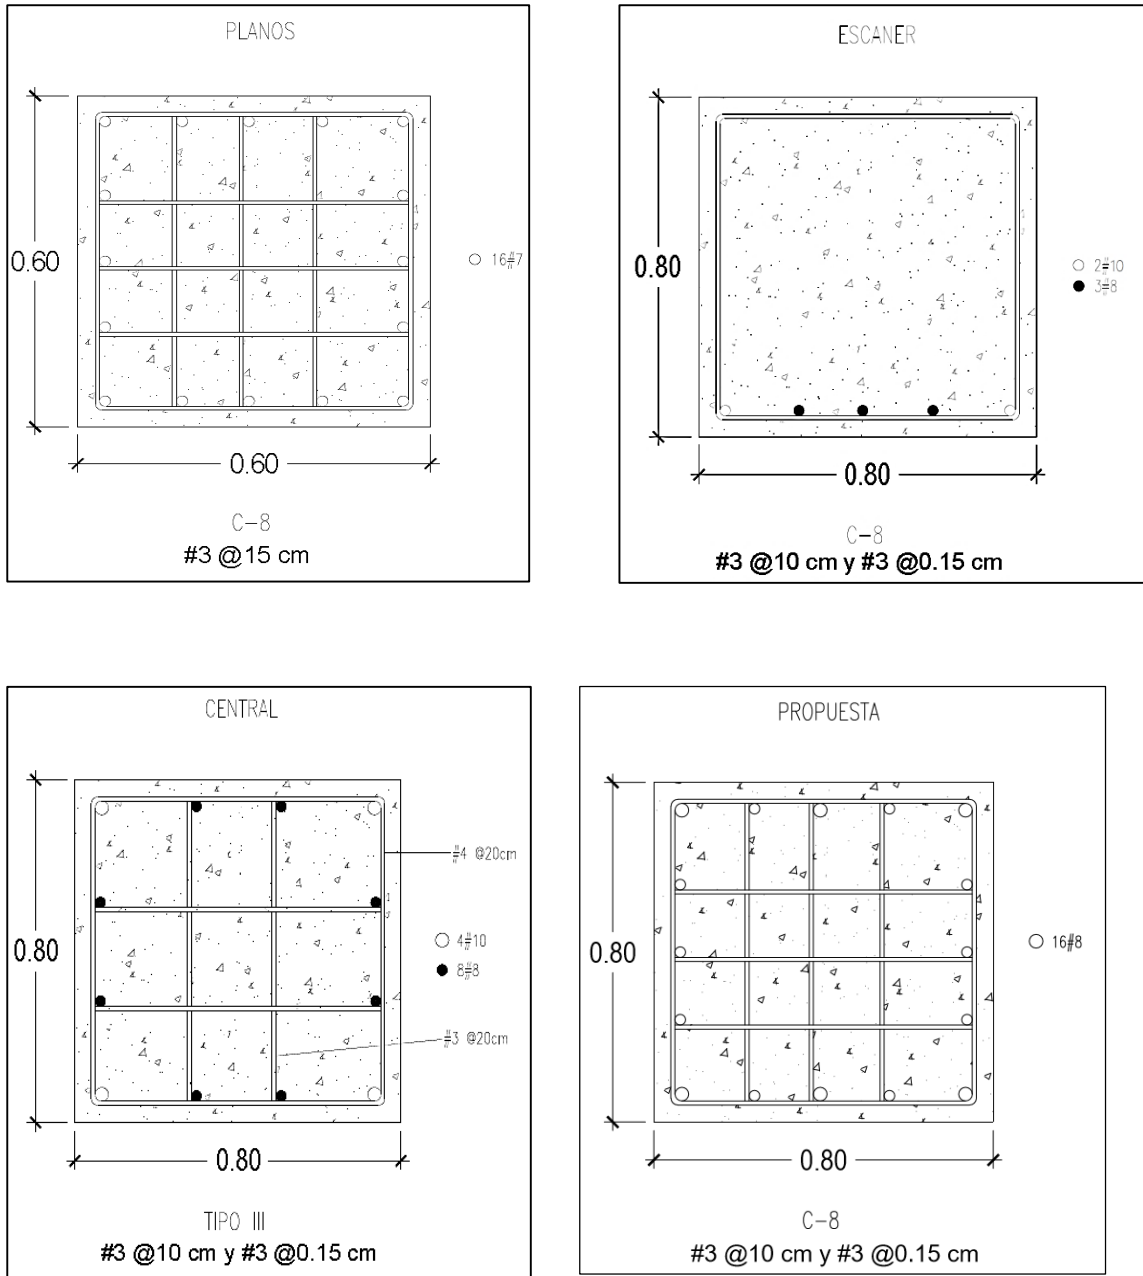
Ejemplo de armado propuesto para una de las columnas de la edificación en estudio.
